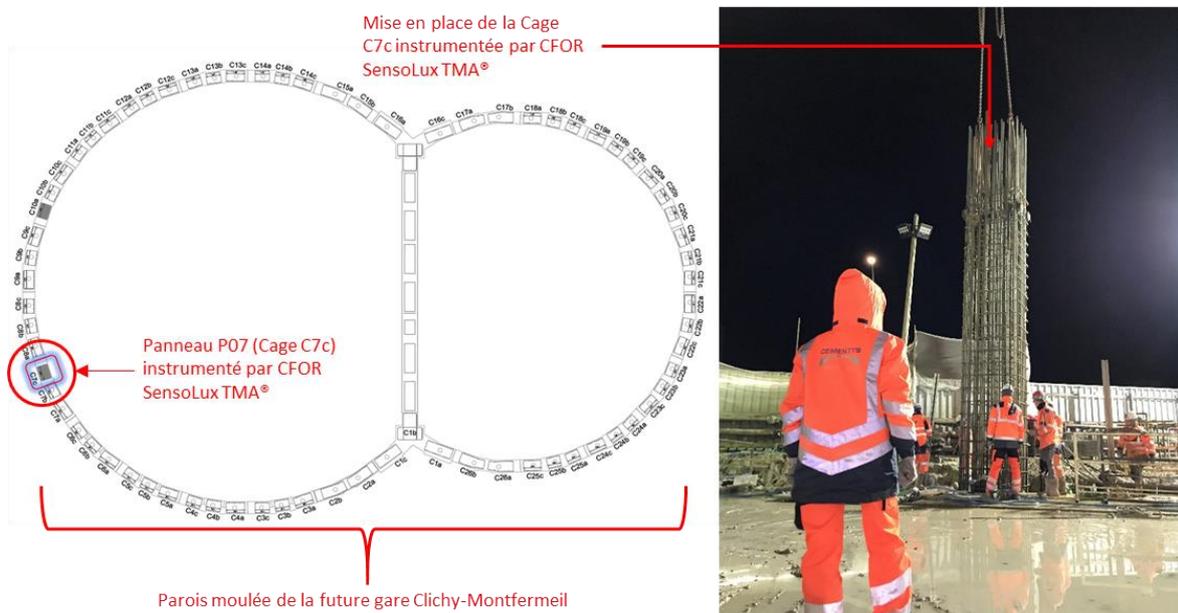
Plan de localisation du panneau P07 (cage C7c) instrumenté à la gare de Clichy-Montfermeil
